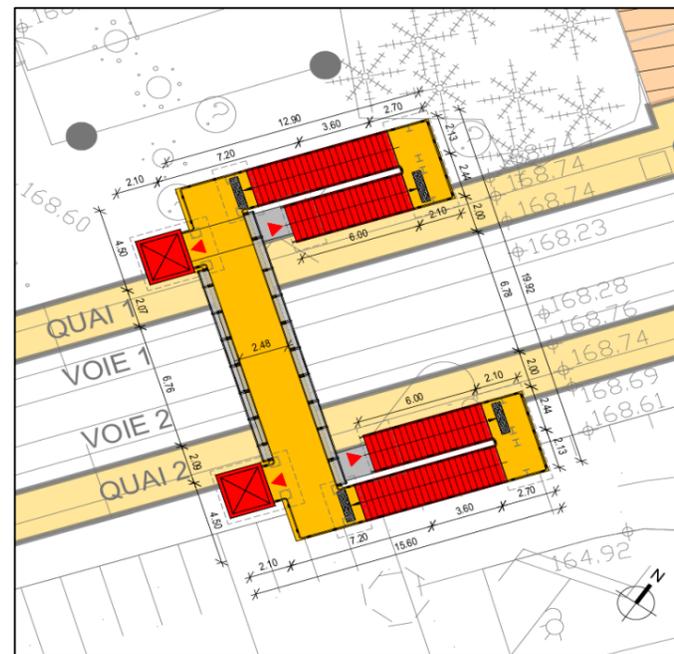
Puget-Ville - principe d'implantation des escaliers (AREP, 2021)
